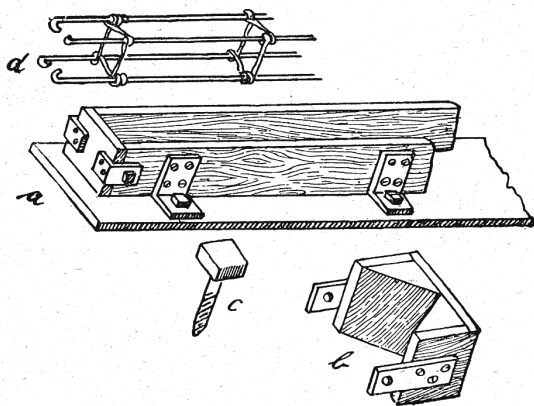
Formkasten für Betonpfosten. a) Kasten mit Fußbrett. b) Kopfriß. c) Befestigungsschraube. d) Teilansicht der Eiseneinlage.
